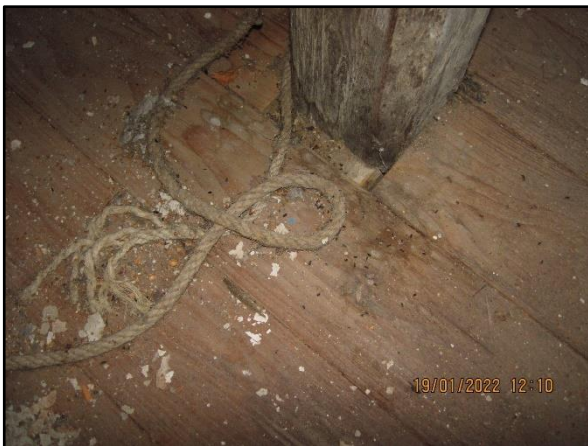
Mäusekot im Dachstuhl des Garagengebäudes
